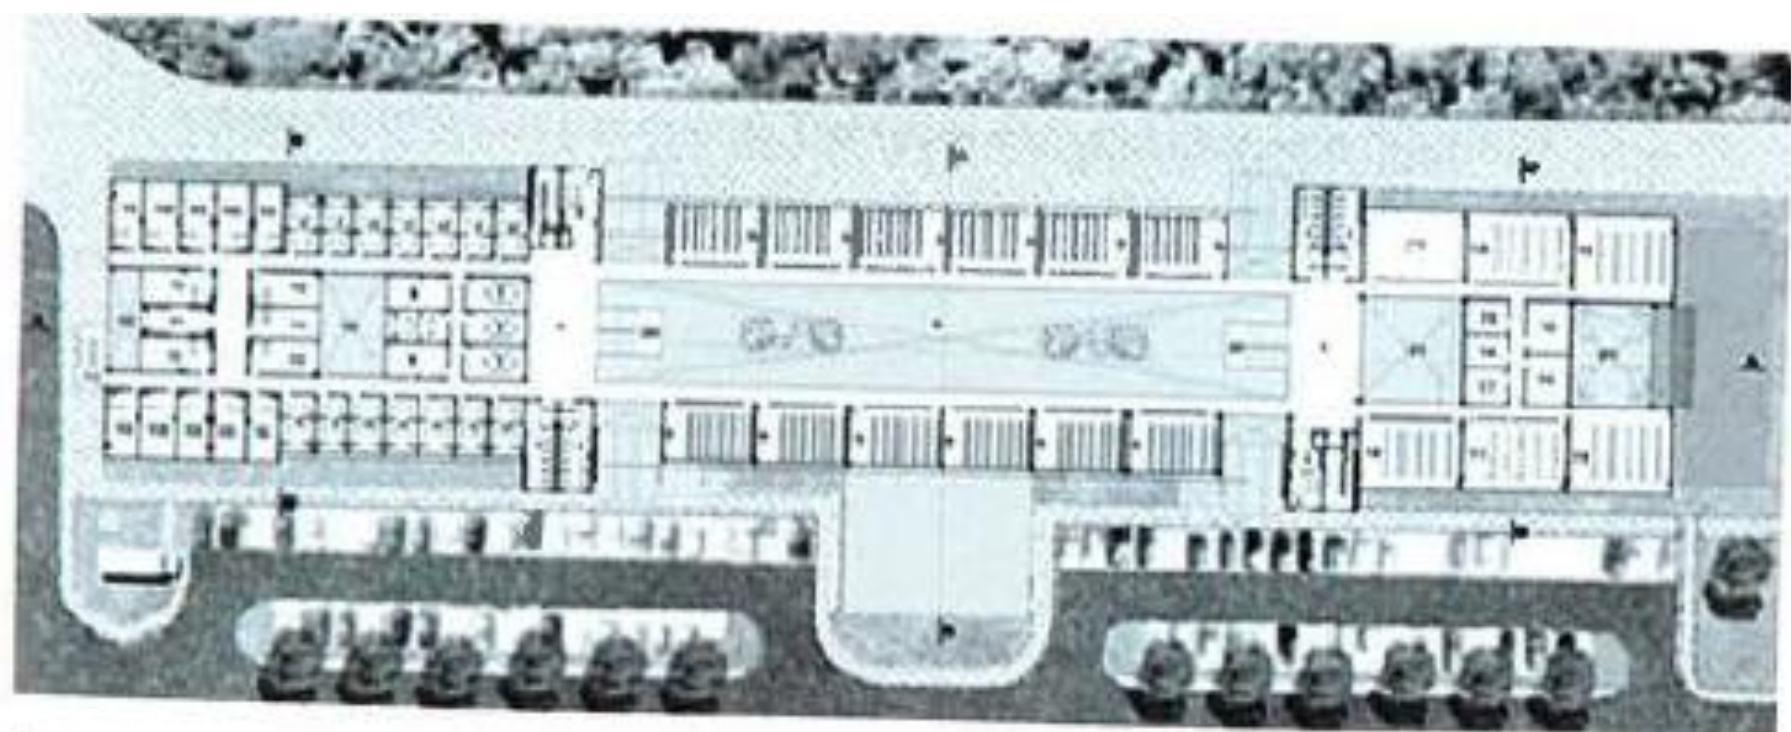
PLANTA TIPO (PAVIMENTOS 1 E 2) DO BLOCO ACADÊMICO
